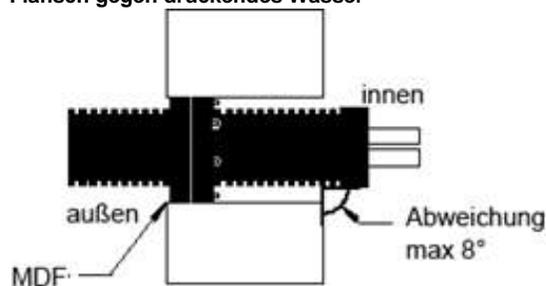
Skizze Mauerdurchführung drückendes Wasser
